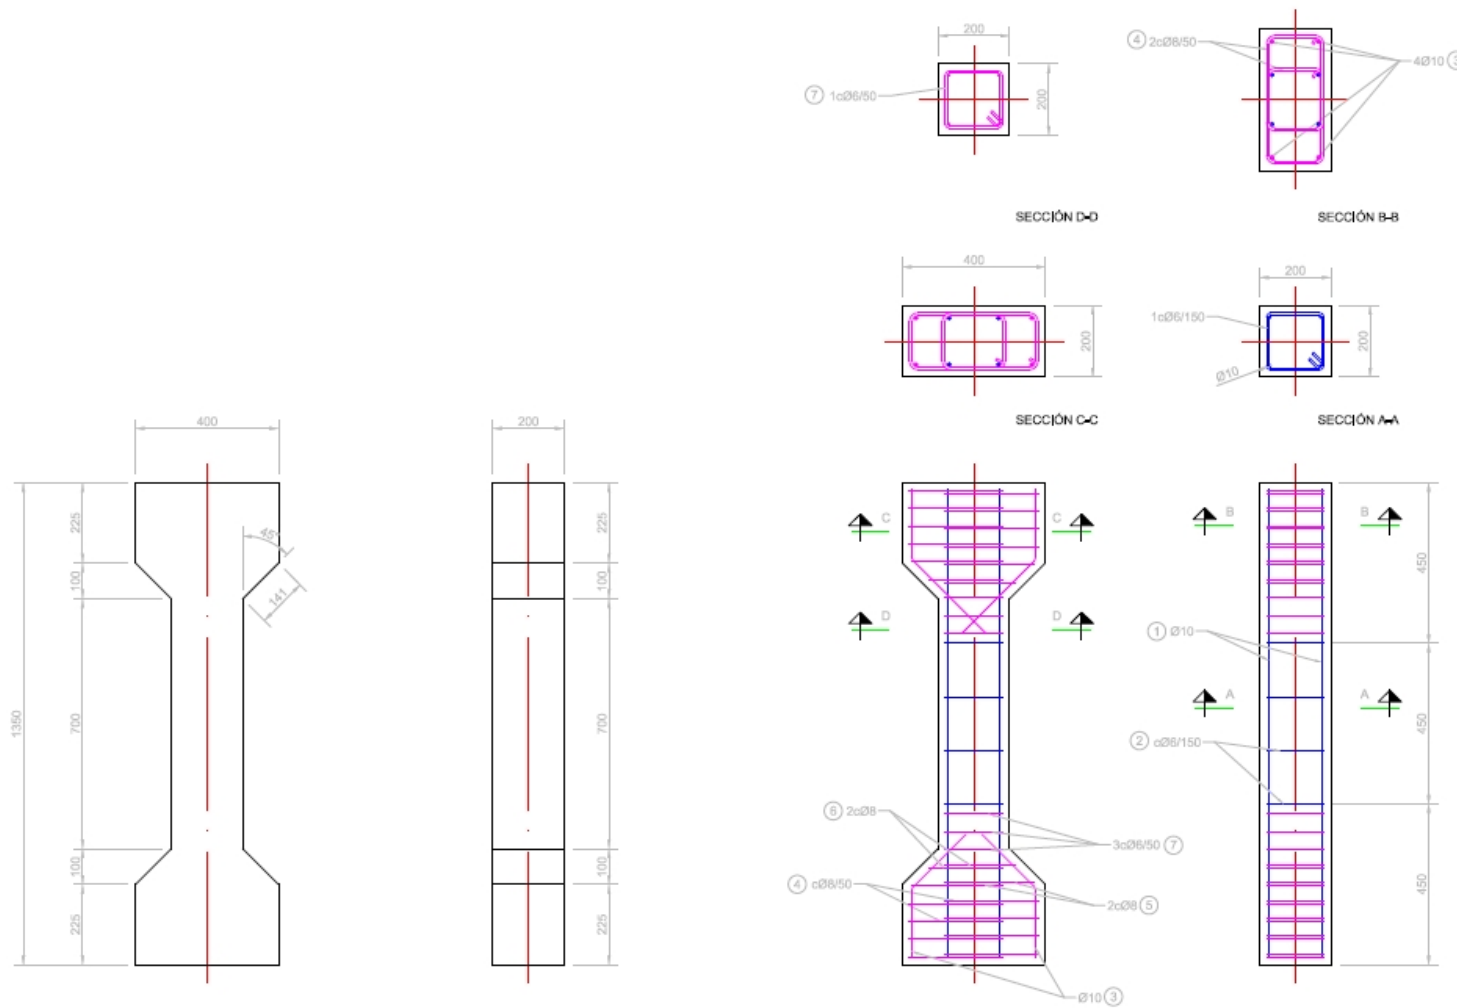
Detalles de la geometría y armado de los pilares previos, segunda fase.
